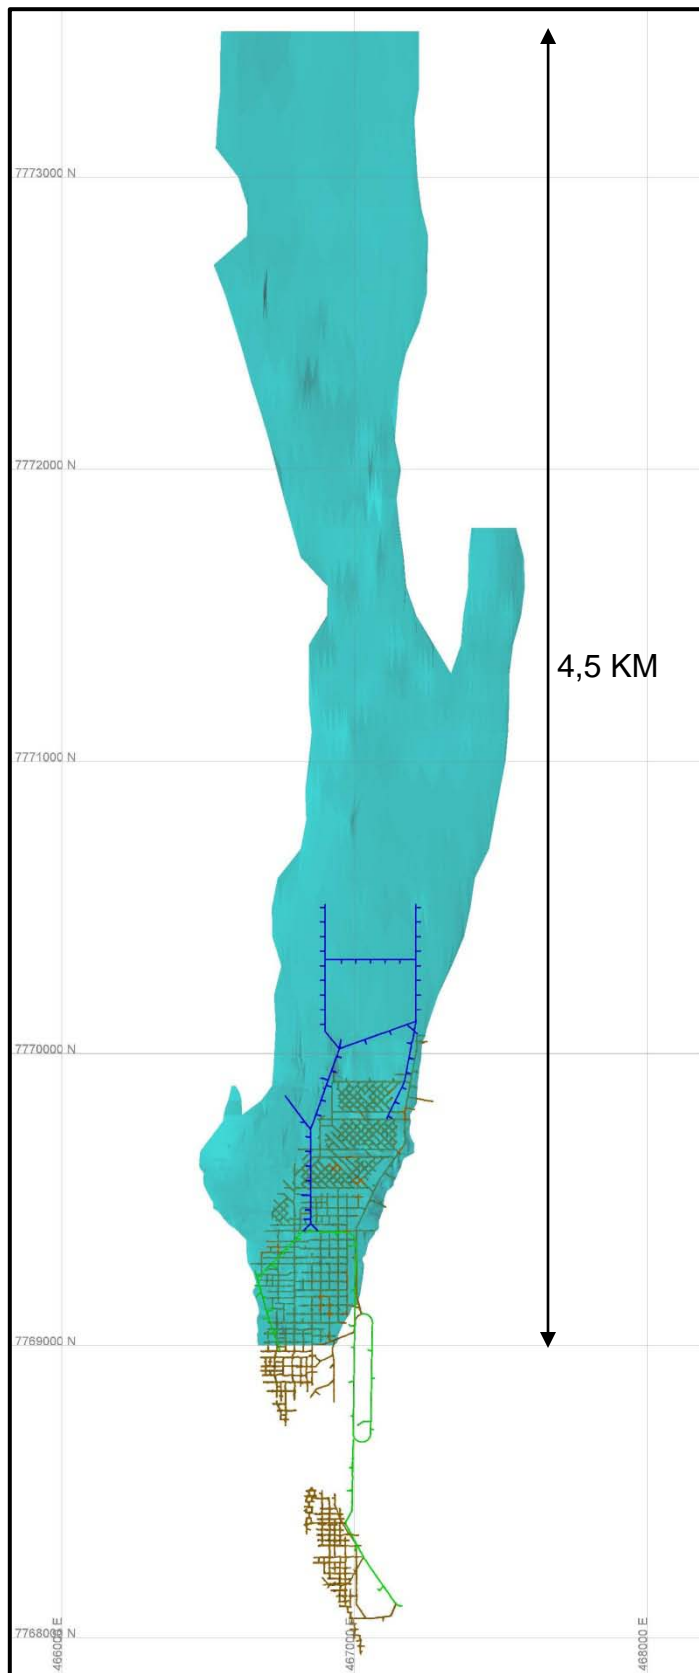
Vista en planta de proyecto Longacho norte y desarrollos.
